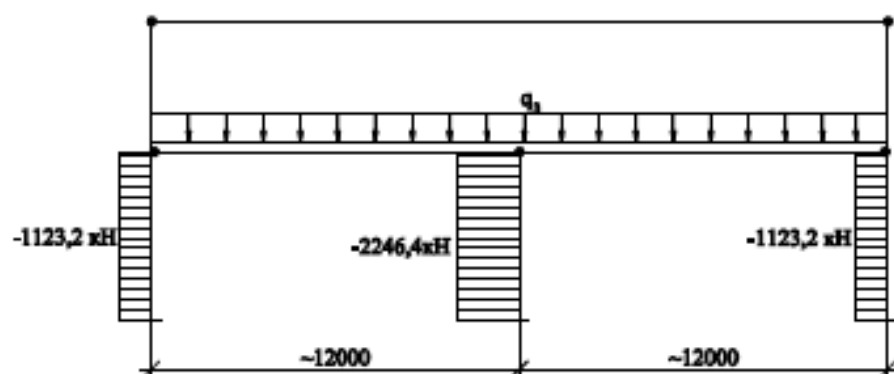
Эпюры усилий в раме от кратковременной нагрузки на ригель перекрытия
